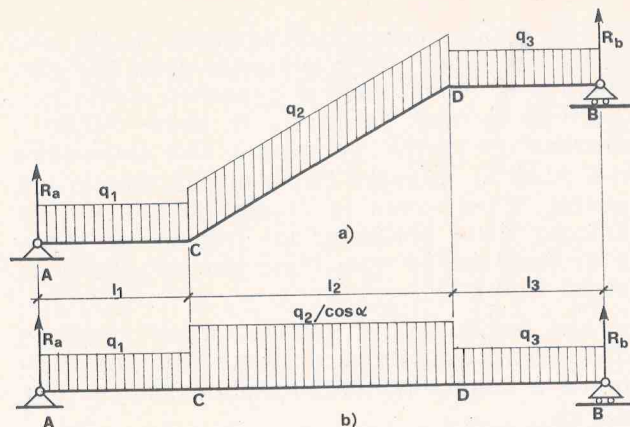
Riduzione della trave a ginocchio doppio simmetrica a) ad una trave isostatica ad asse rettilineo b).
